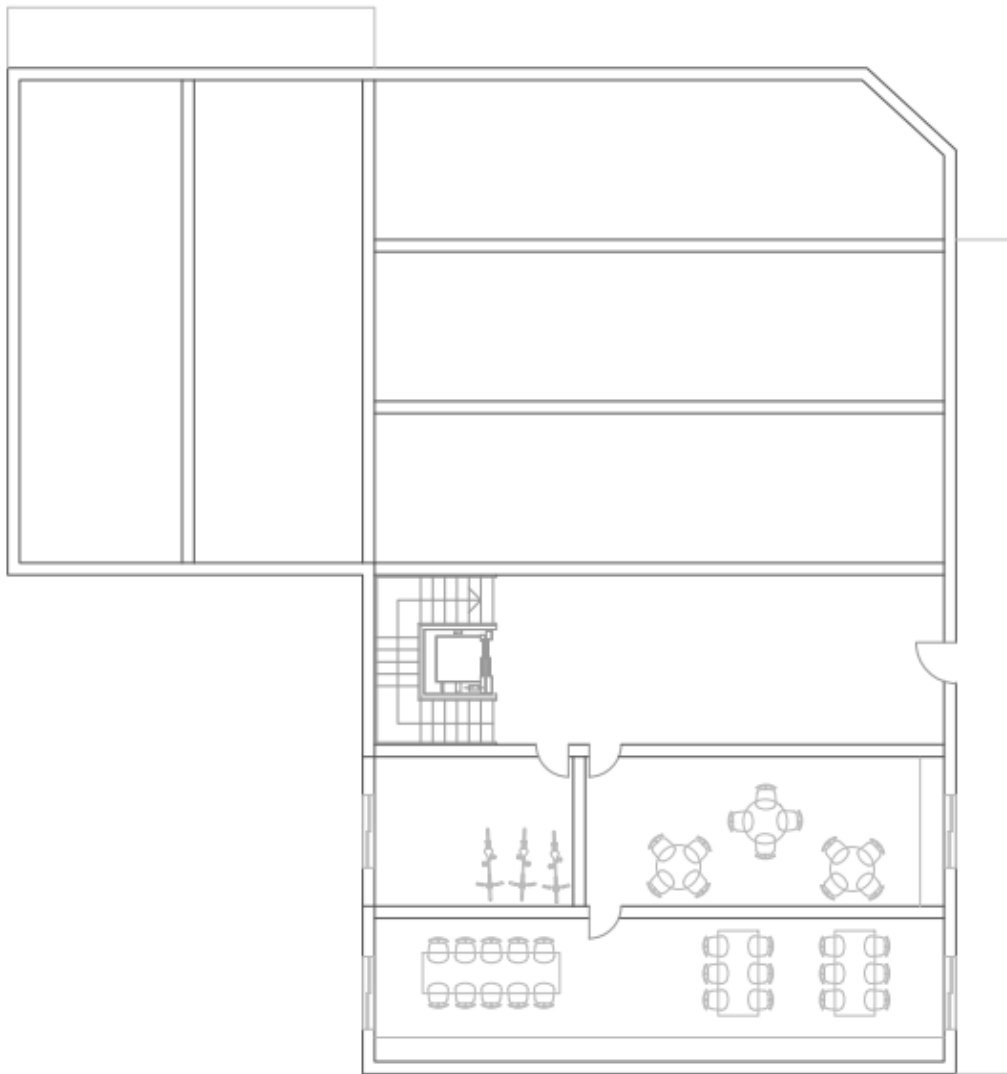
Planta de cota 0 del edificio tipo con estructura de entramado ligero de madera realizada en AutoCAD.
